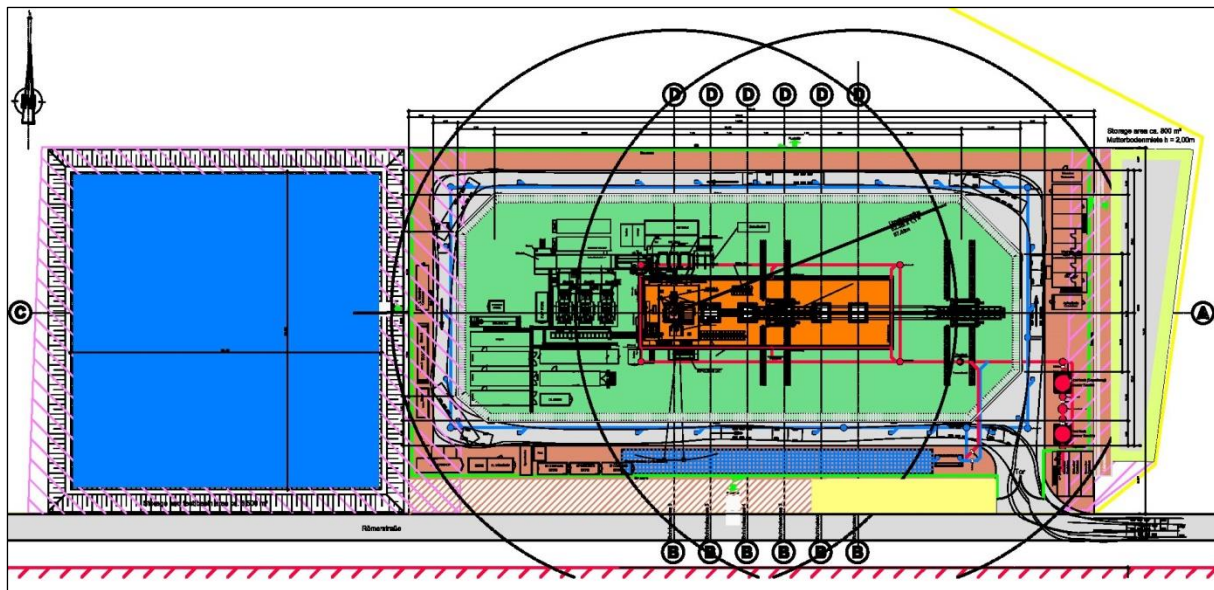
Lageplan Bohrplatzkonzept „Laufzorn II“
